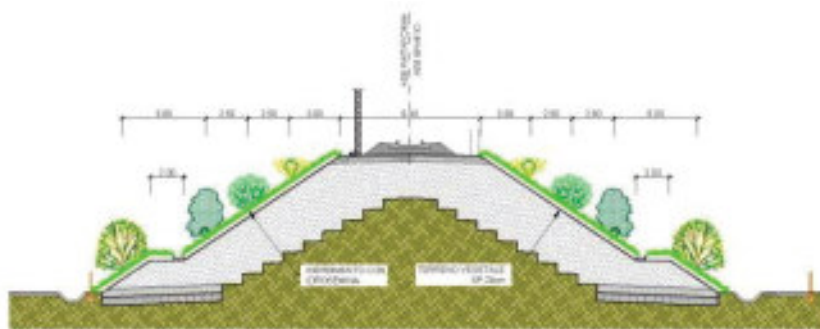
Sezione tipo dei rinverdimenti dei rilevati
